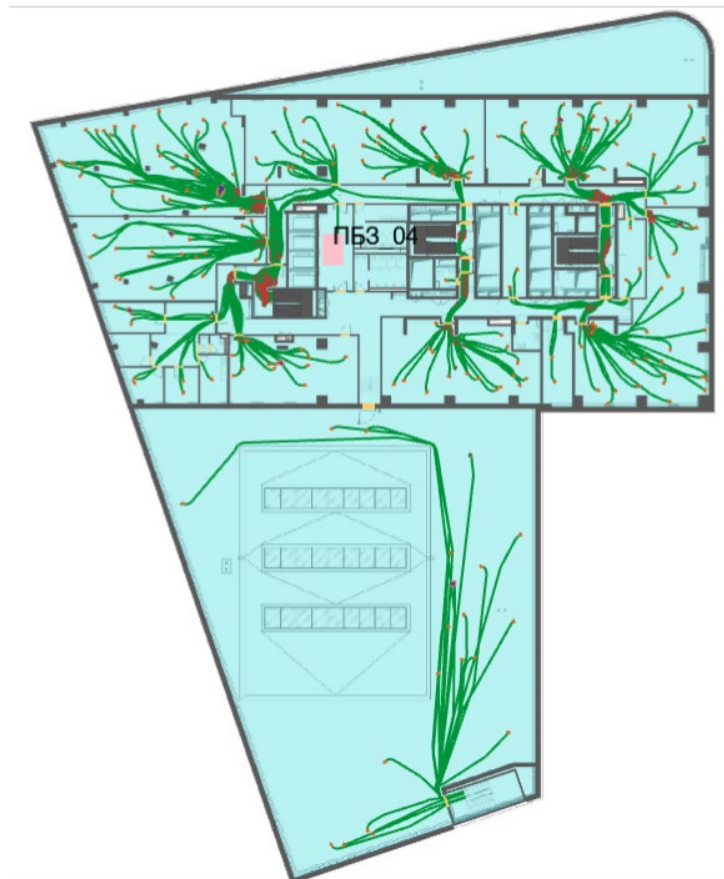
План 4-го этажа и нанесенная на него расчетная (принципиальная) схема эвакуации
